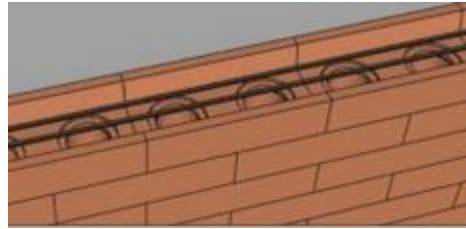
Detalle barras de acero en refuerzo horizontal, sistema constructivo Siconte
